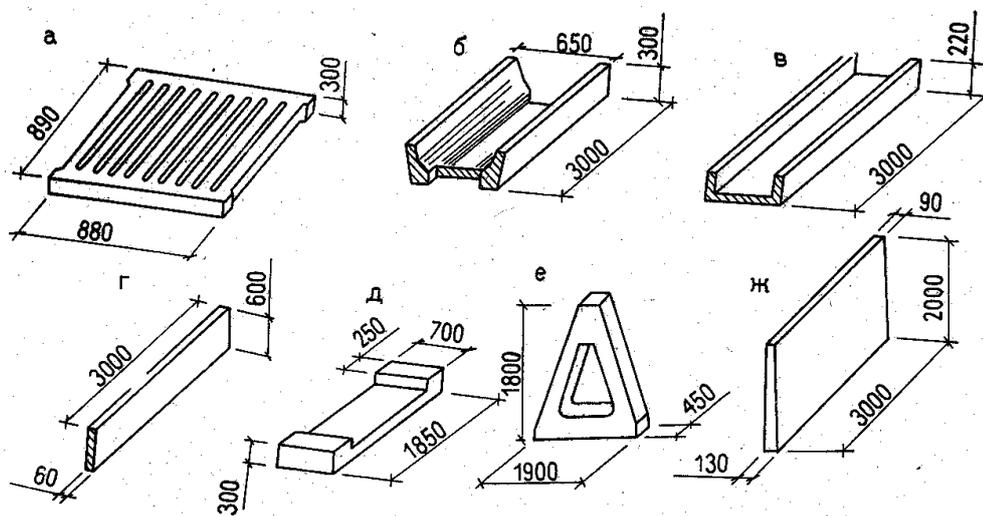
Железобетонные конструкции сельскохозяйственных зданий:
